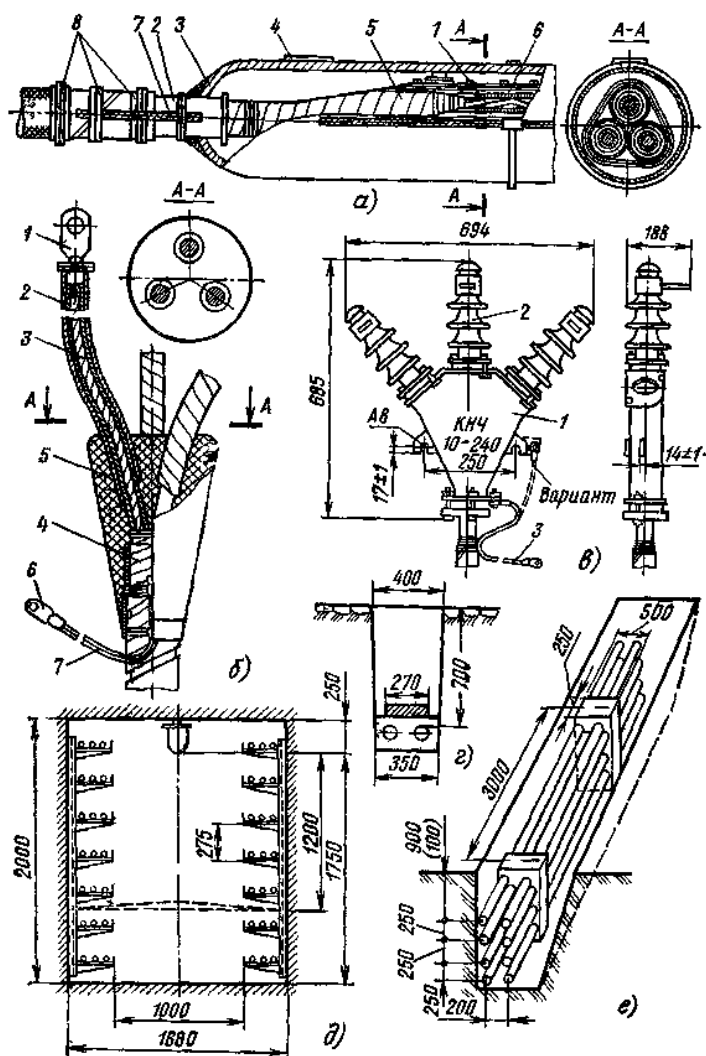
Арматура и способы прокладки кабелей: а – свинцовая соединительная муфта для кабелей 6-110 кВ; б – концевая заделка типа КВЭ с пластмассовыми трубками на жилах; в – трехфазная концевая муфта наружной установки типа КНЧ для кабелей 6-10 кВ; г – прокладка кабелей в земляных траншеях; д – проходной кабельный туннель; е – кабельный блок
